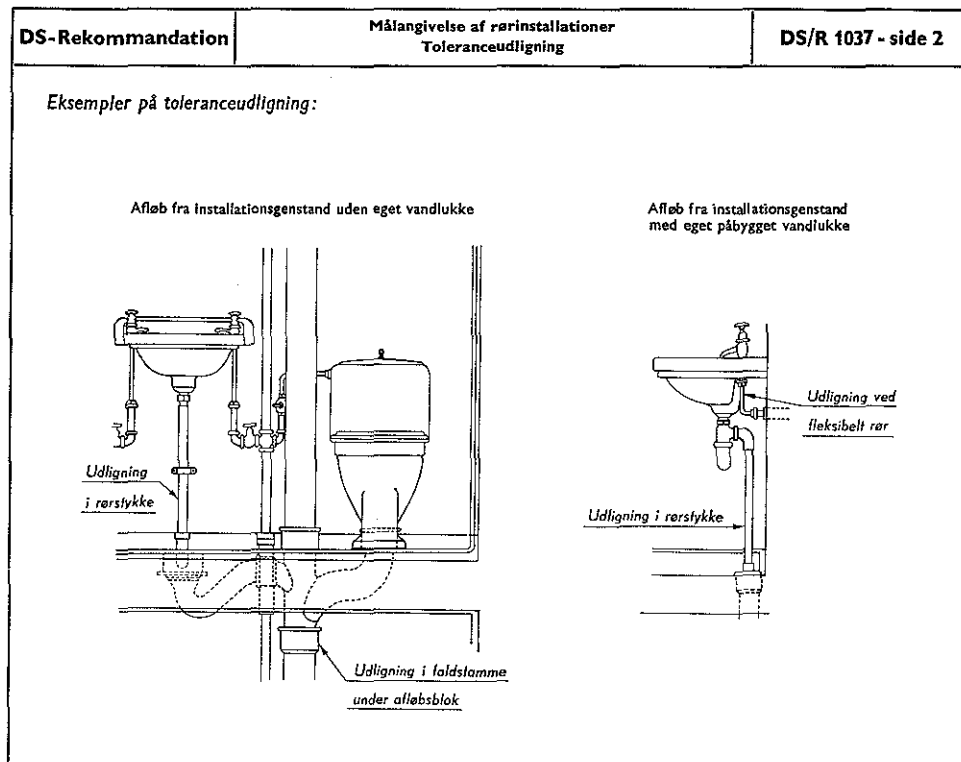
DS/R 1037 Toleranceudligning.
